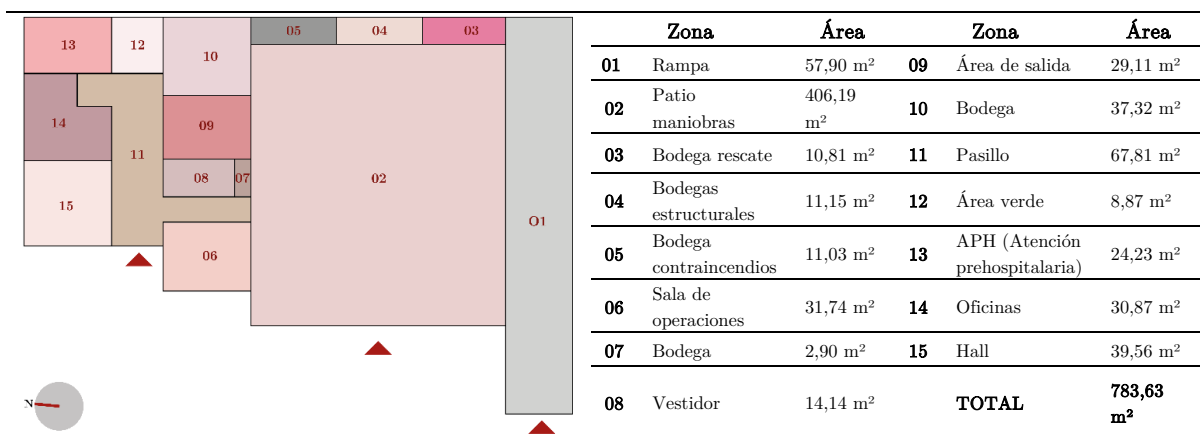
Organigrama de planta baja. Elaboración: Propia.
